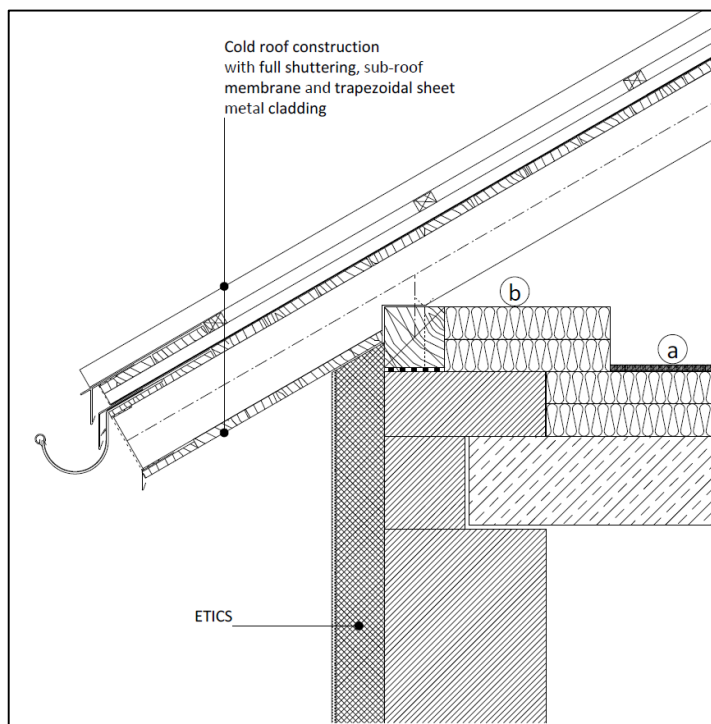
<sup>15</sup> Термоизоляция бетонной плиты крыши у скатной кровли
